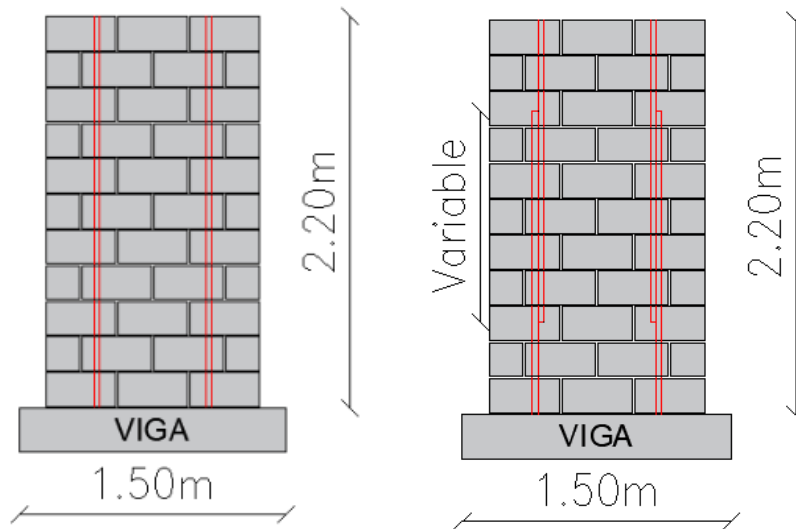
Posicionamiento de las barras de GFRP dentro del Muro. (Arley & Gómez, 2020)
